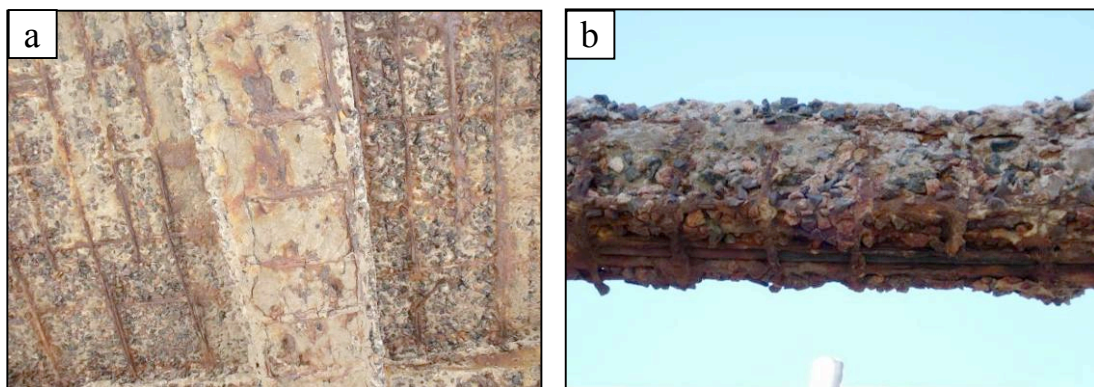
a: Cambios de coloración en el espigón Oeste, b: Fisuras en el espigón Este.
